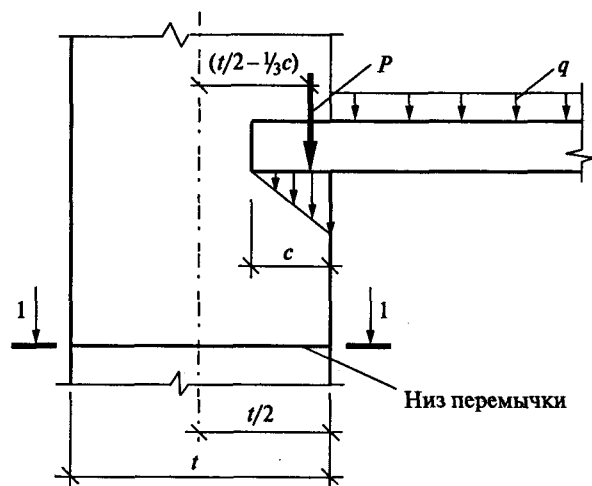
Нагрузка от перекрытия на стену:  $t$  — толщина стены;  $c$  — длина опирания перекрытия на стену
